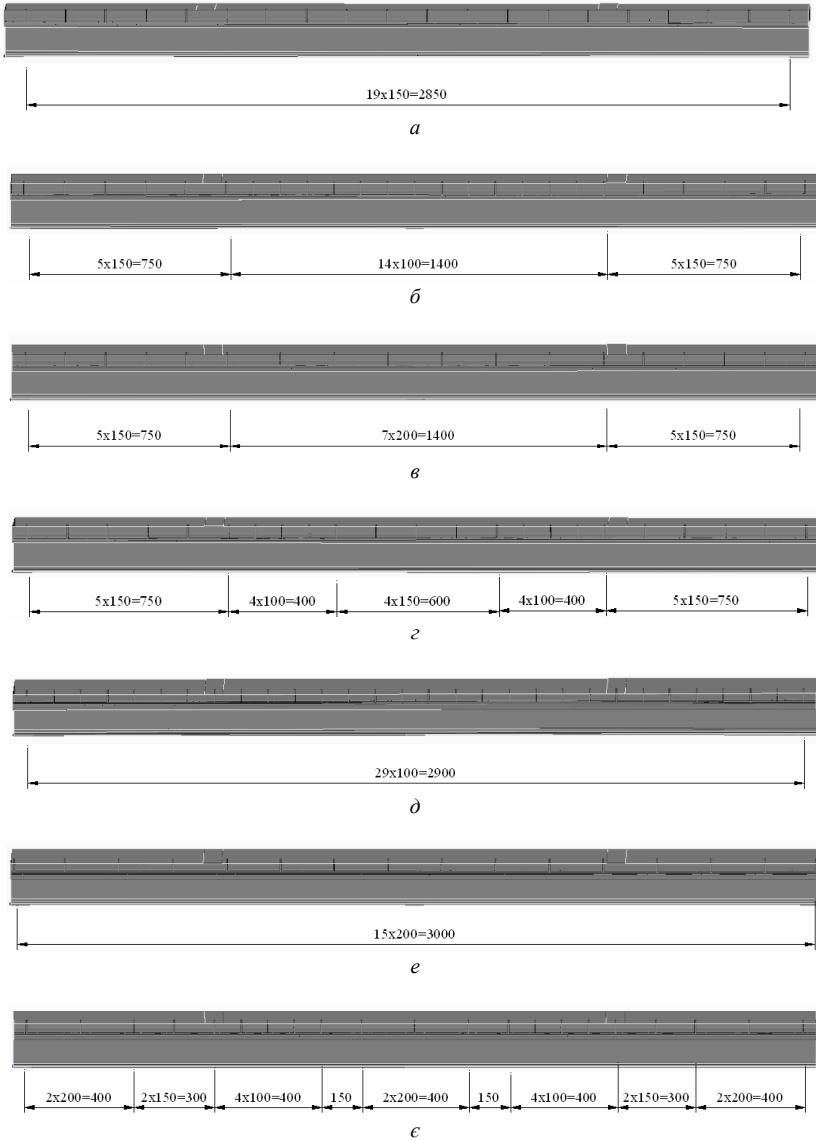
Типізація досліджуваних кроків гнучких анкерів у моделях сталезалізобетонних двопролітних балок
